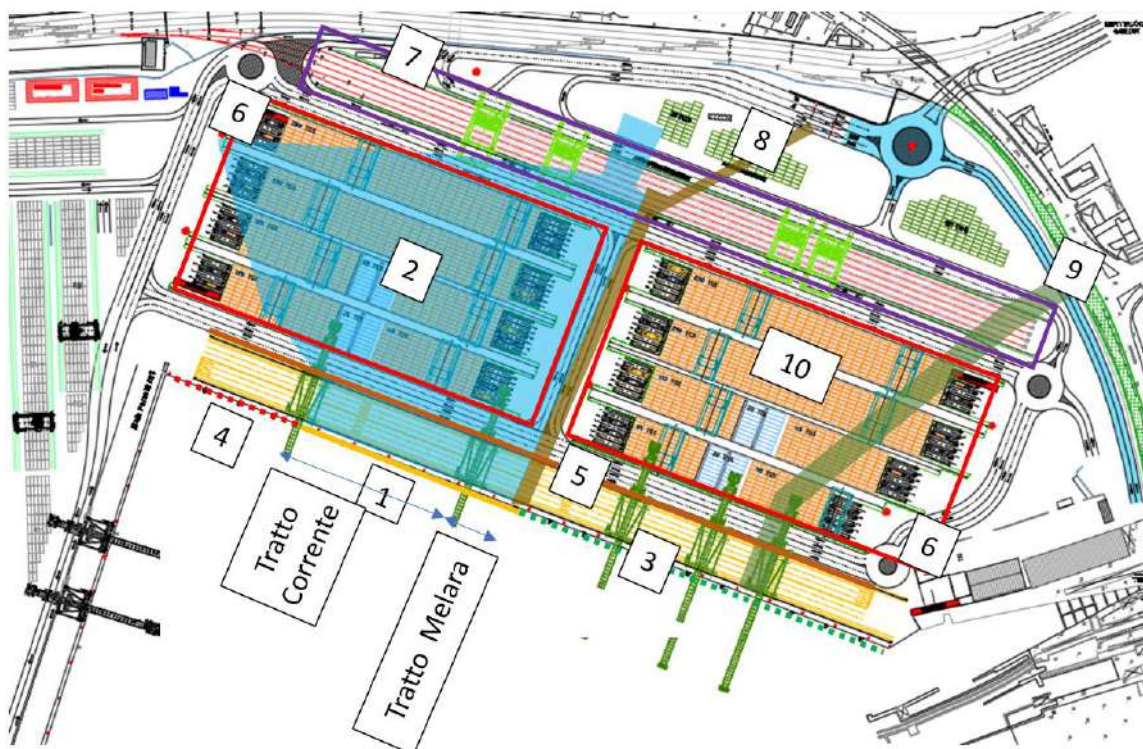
Individuazione in pianta delle tre tratte della banchina Ravano
